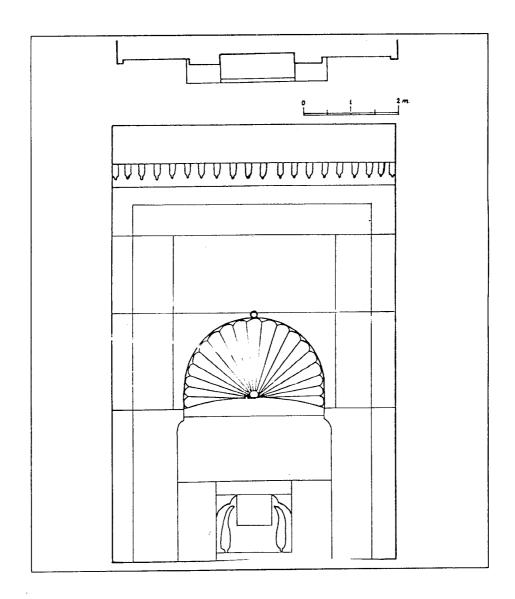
مسقط أفقي لحشمة سنان أغا باشا في أدرنه (عن :Ö N G E).
